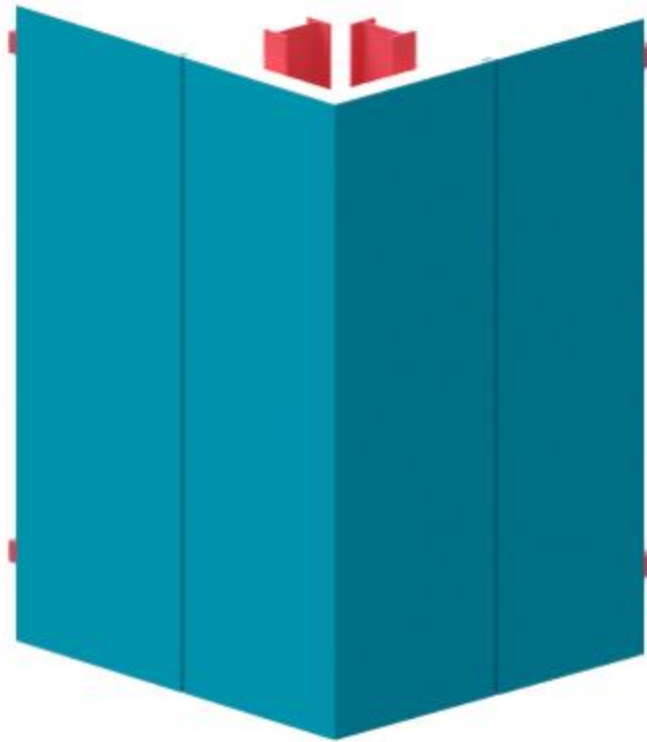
Exemple d'angle sortant assemblé sur site en pose horizontale avec panneau sandwich isolant Louvre
